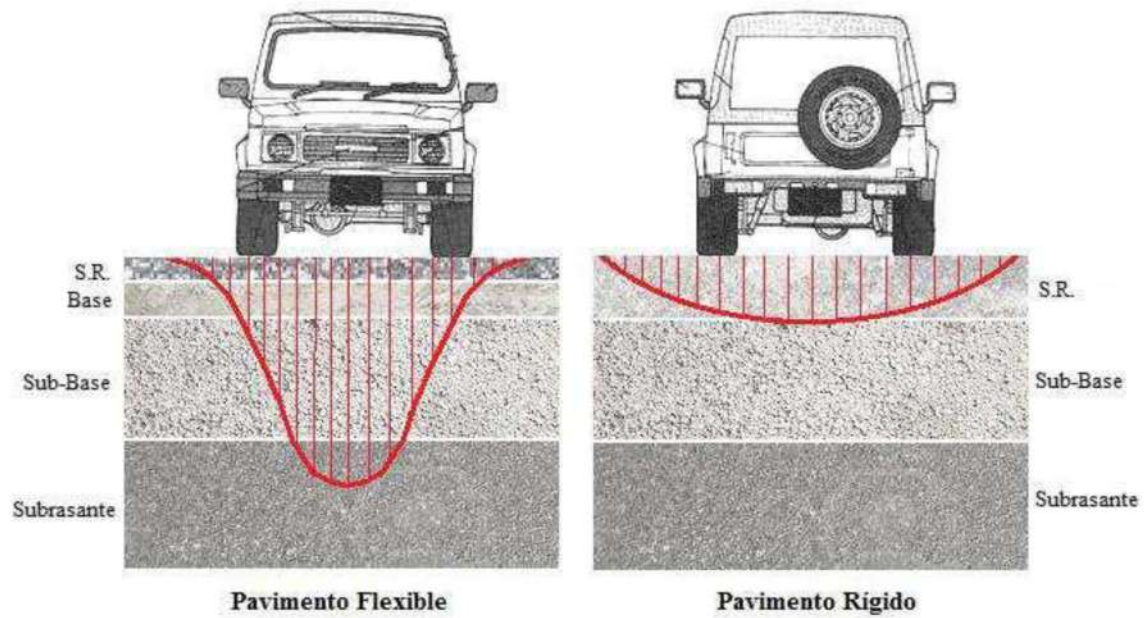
Distribución de esfuerzos en la estructura de pavimento flexible y rígido.
